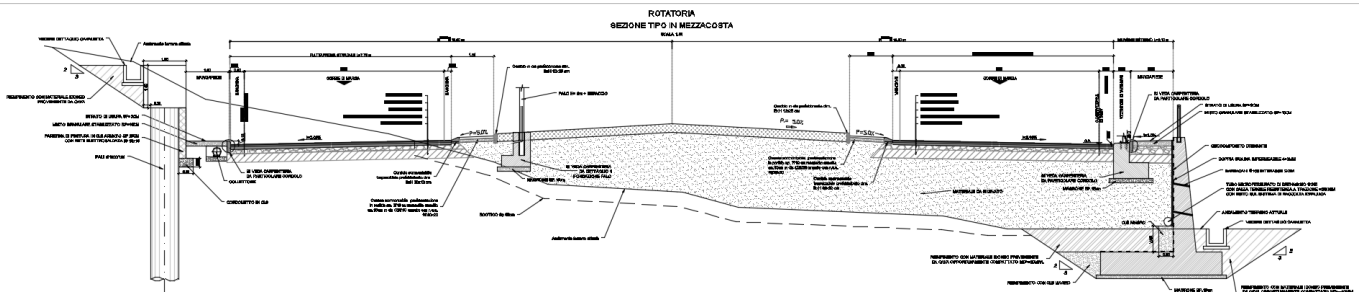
Asse 1 – Sezione tipo in mezzacosta
